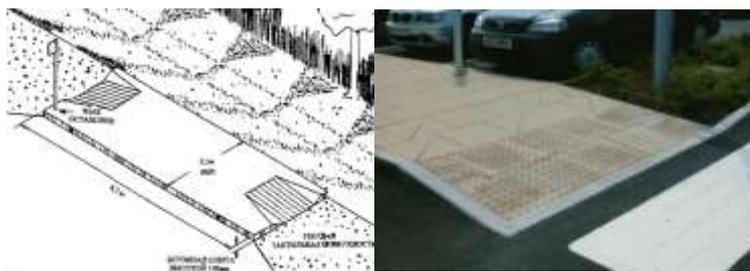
Пример оборудования посадочной площадки пандусами
